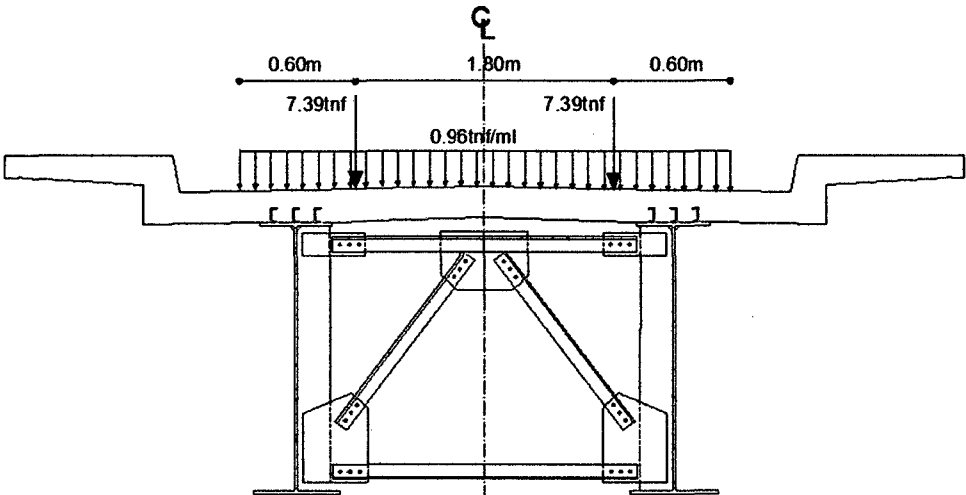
Ubicación de la carga móvil centrada sobre la viga diafragma - Primer y Segundo Tramo.
